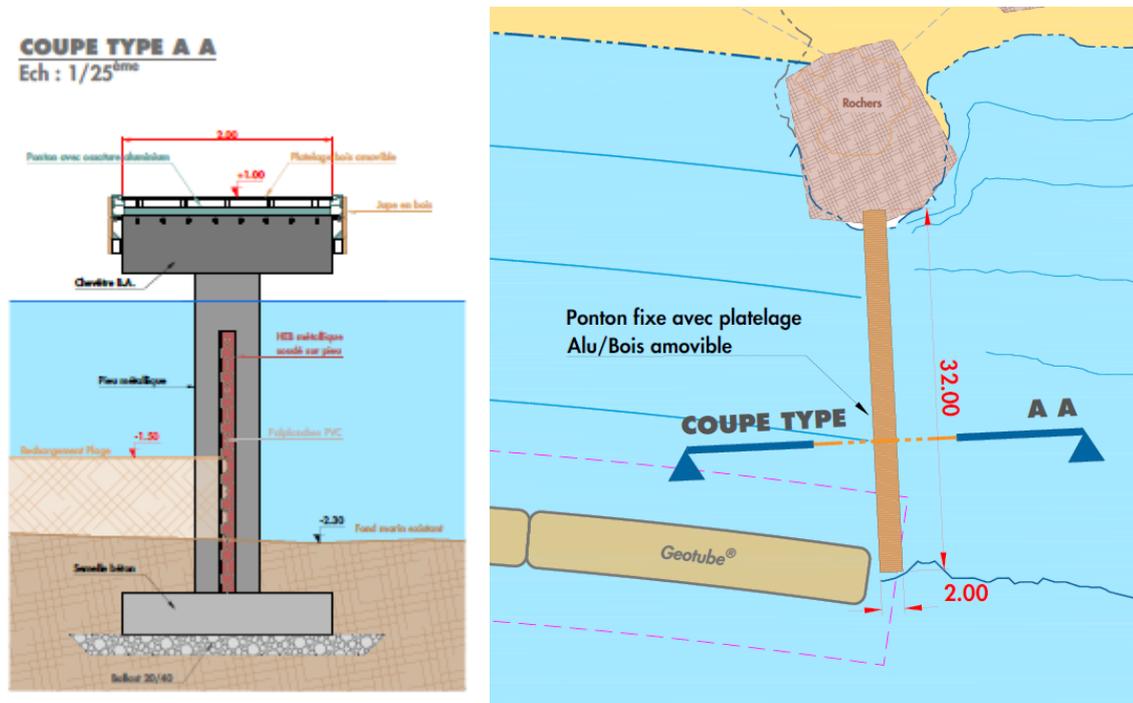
Vue en plan et coupe ponton butée de pied @ CORINTHE Ing
